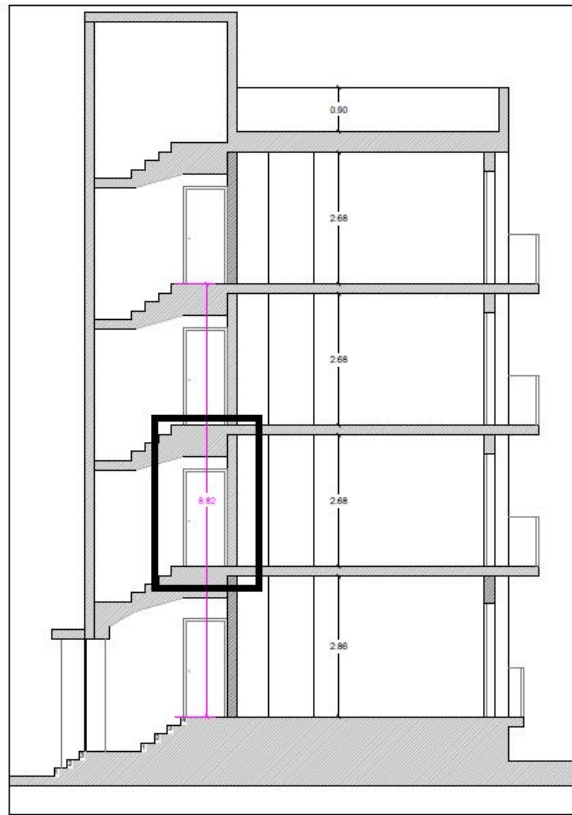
Sección justificación altura entre plantas(Fuente: Anejo A)
